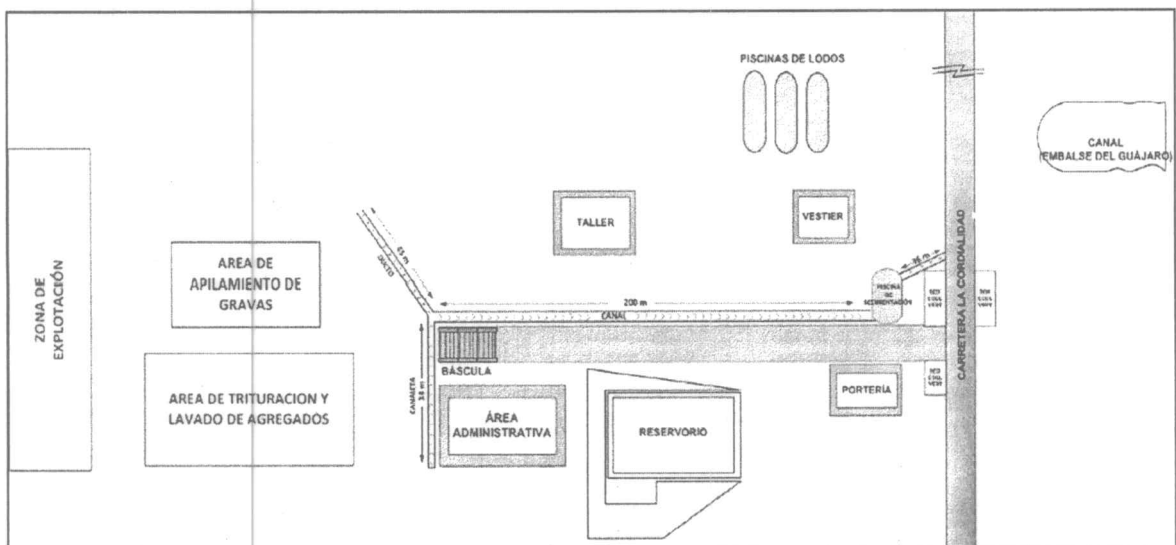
Sistemas de canales - Planta de agregados de Arroyo de Piedra.
